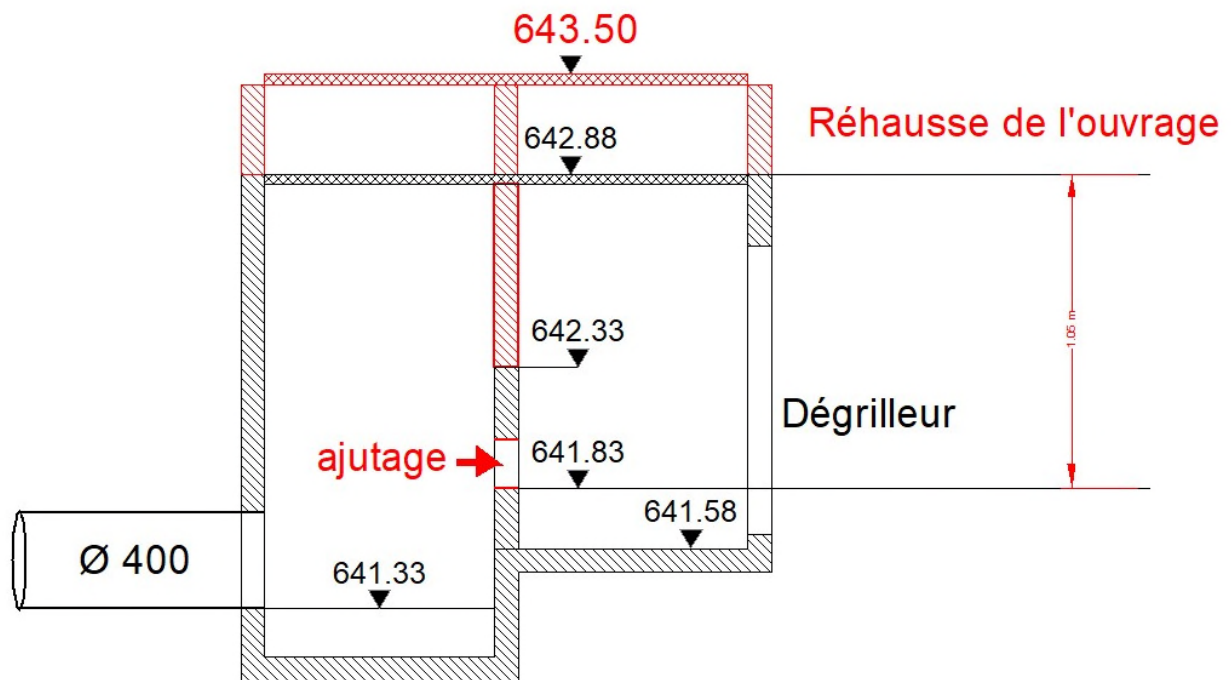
Plan de détails de l'ouvrage de régulation à modifier
